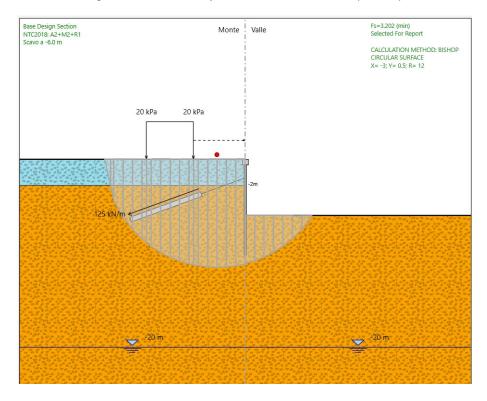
Sezione Tipo B - Condizioni statiche (FS=3.2)
